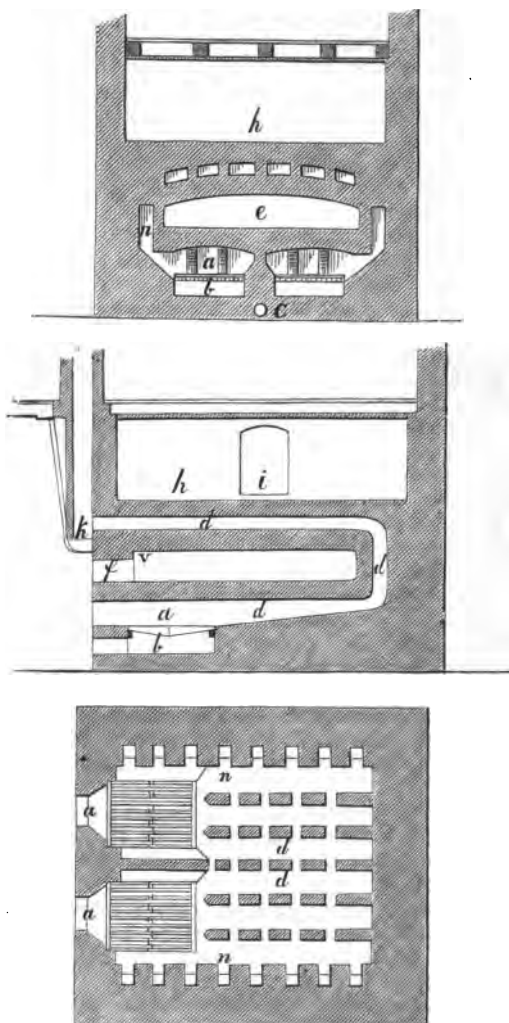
Badofen; Grundriß, Längen- und Quer-Profil.
